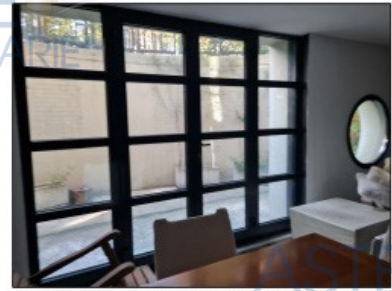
DETTAGLIO INFISSO CANTINA INTERRATA
